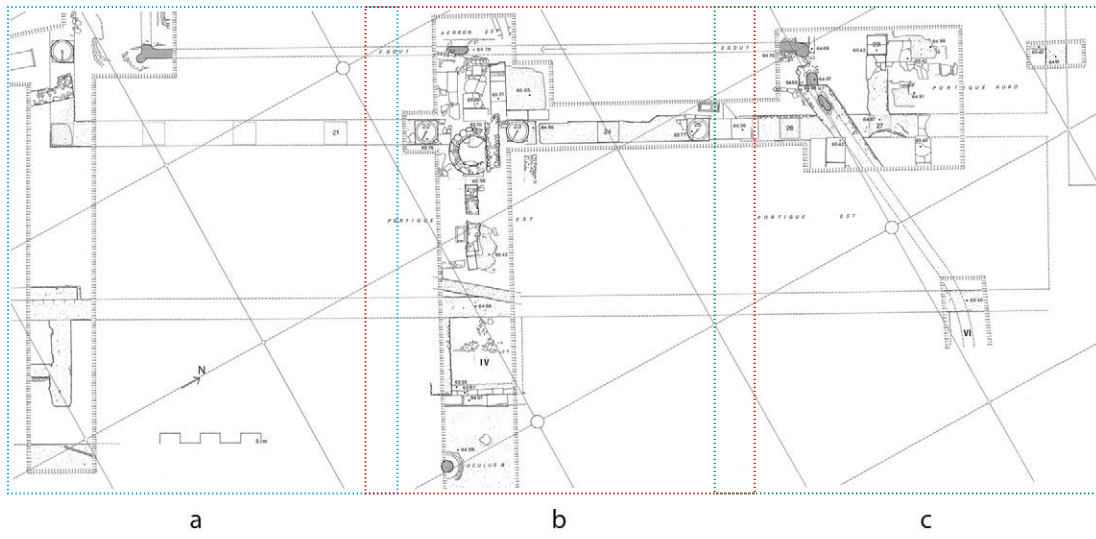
Plan de détail de la colonnade orientale (G. Hallier).
